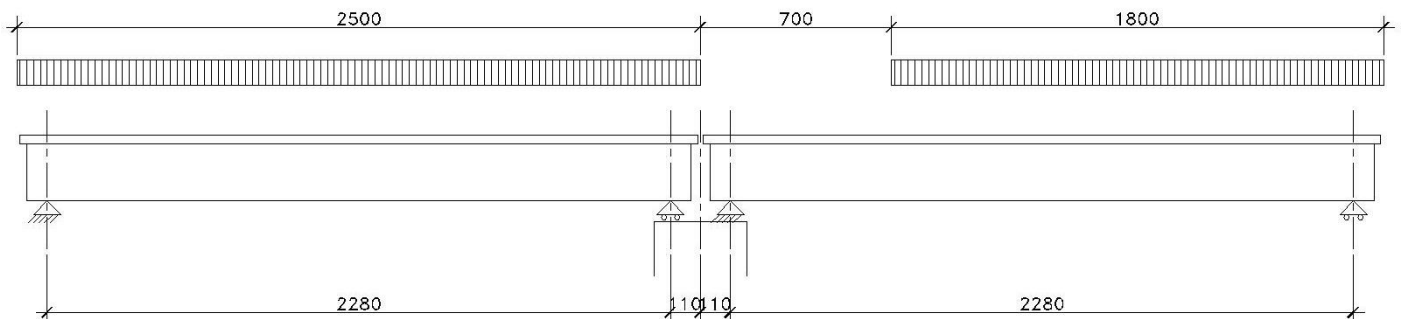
Configurazione di carico 3 – Disposizione dei carichi in direzione longitudinale
